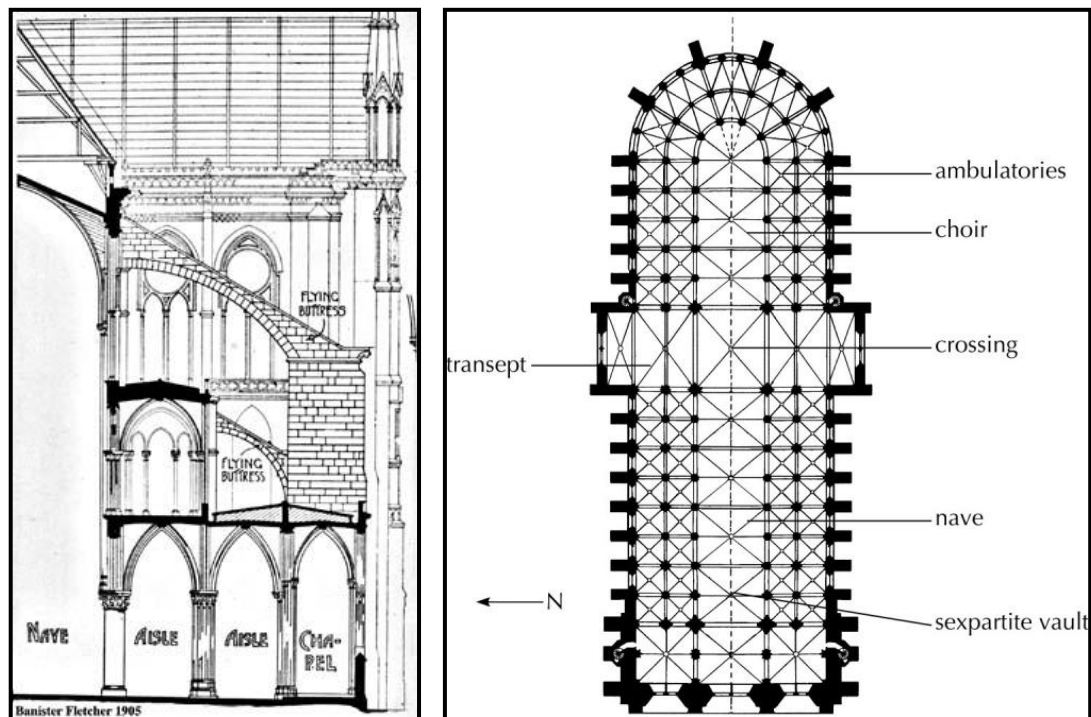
Sección y Planta de la Catedral de Notre Dame de París.
